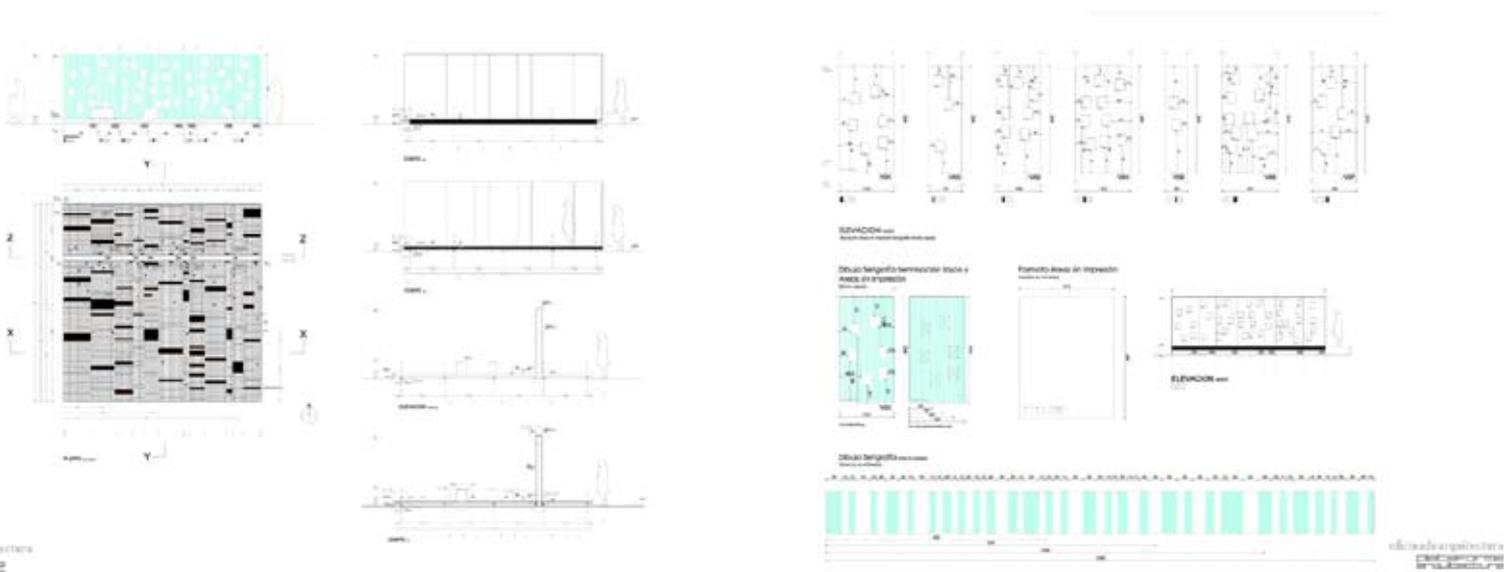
Planos de planta del proyecto Mujeres en la Memoria.
